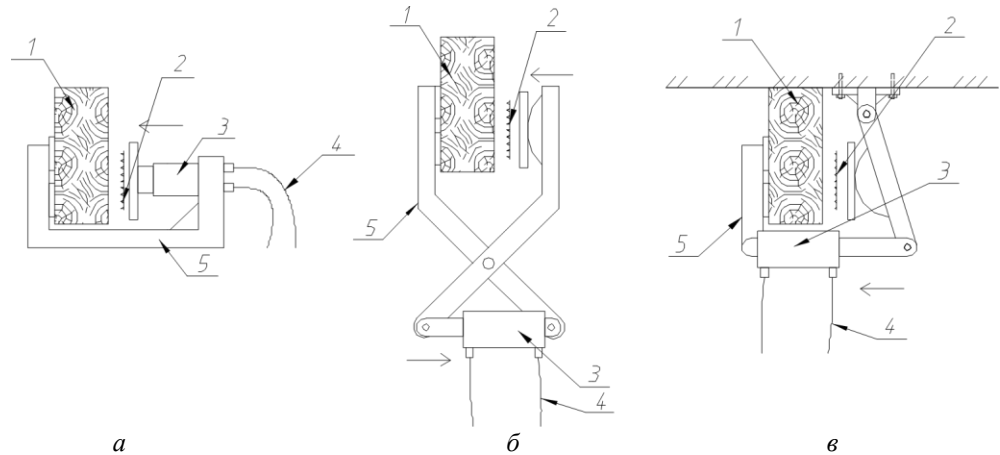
Способы запрессовки МЗП для усиления балки: *а* – по типу «скоба»; *б* – по типу «ножницы»; *в* – с опорой на плиту перекрытия; 1 – деревянная балка; 2 – МЗП; 3 – гидравлический цилиндр; 4 – гидропривод; 5 – опорное устройство
